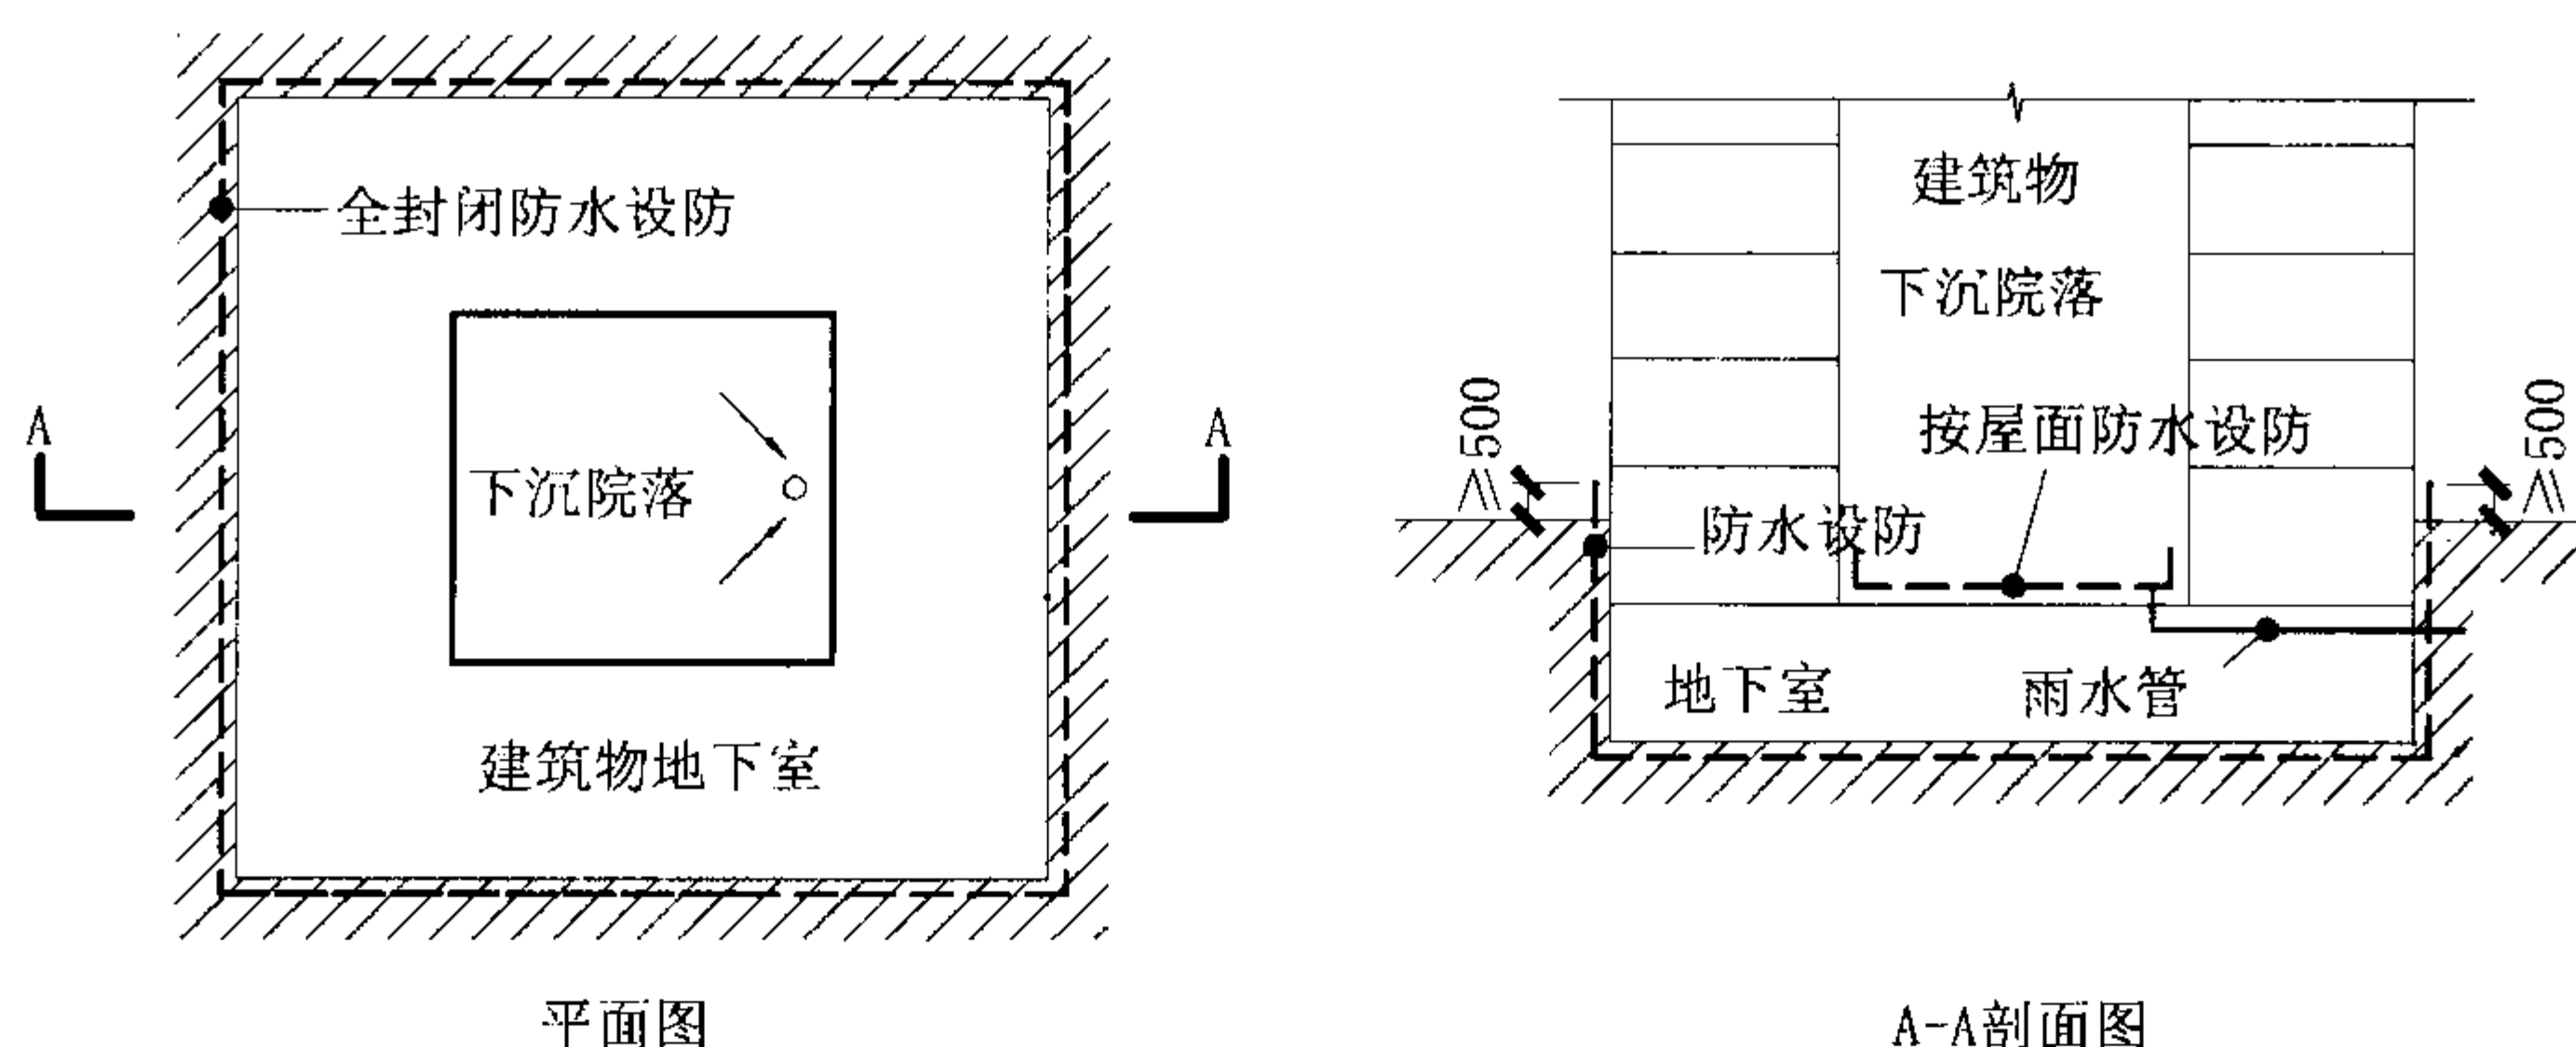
建筑物地下室防水设防示意三 (mm)
